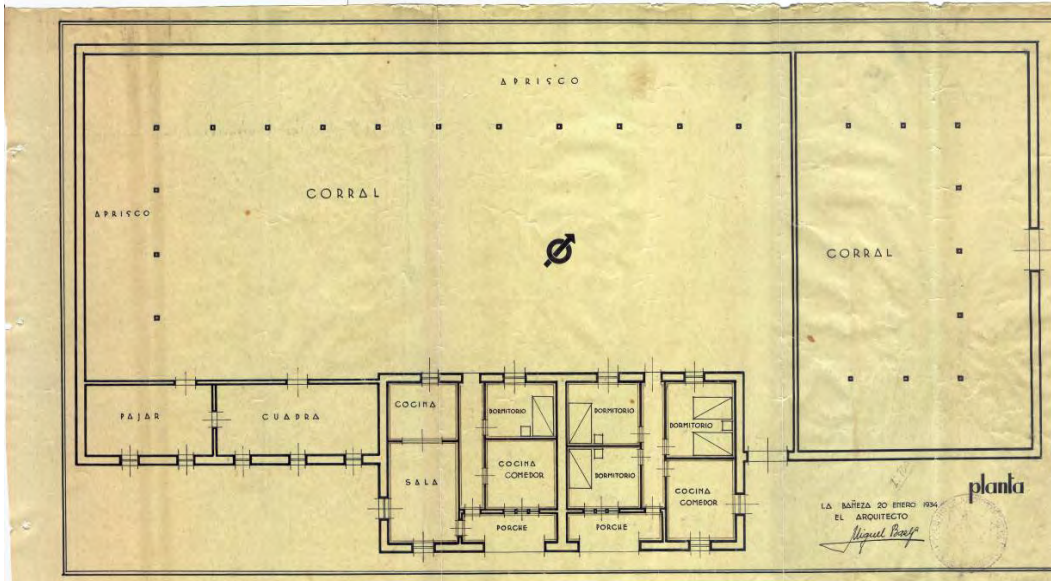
Plano de planta procedente del proyecto. Archivo familiar.
